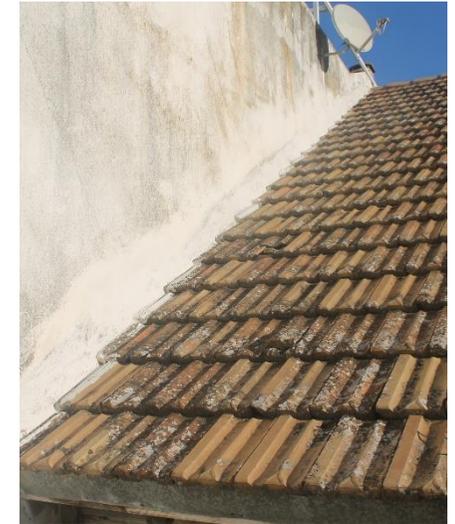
Muro medianero oeste desde el interior de la nave. Fig. 16 Muro medianero oeste exterior sobre la cubierta. Fotos del Autor.
